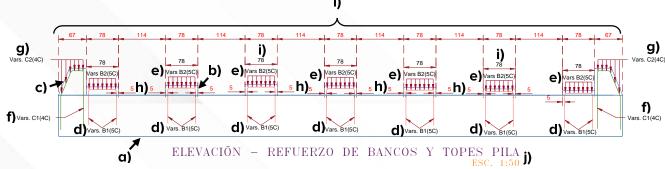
Ejemplo de elevación del refuerzo de bancos y topes de pila
